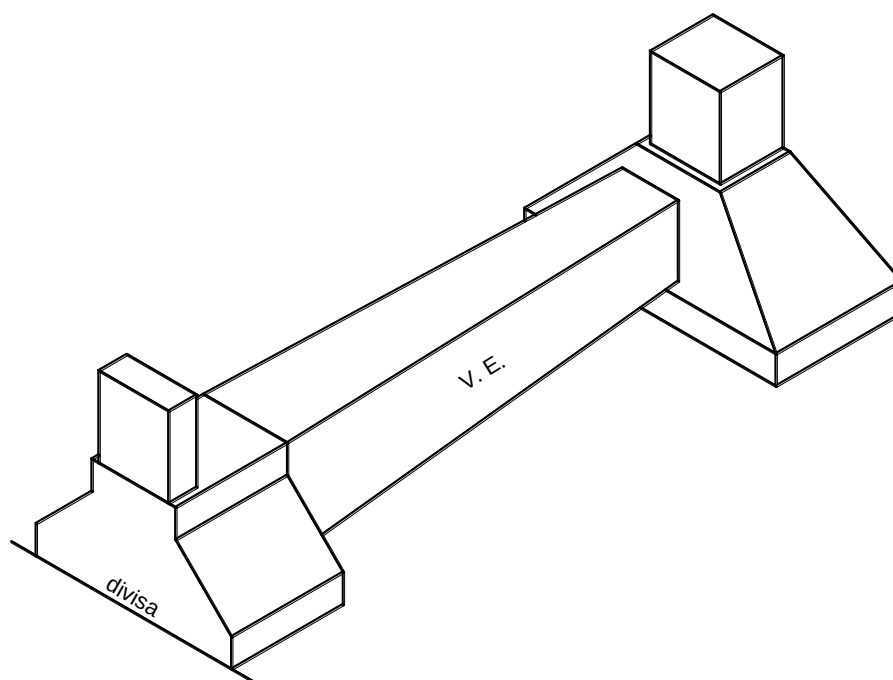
Sapata sob pilar de divisa e associada à viga de equilíbrio.
